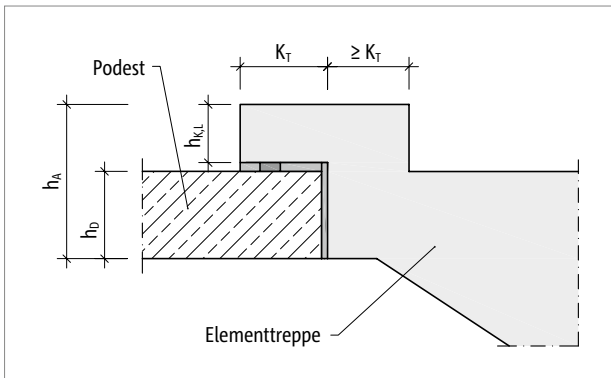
Schöck Tronsole® Typ BL: Bemessung
